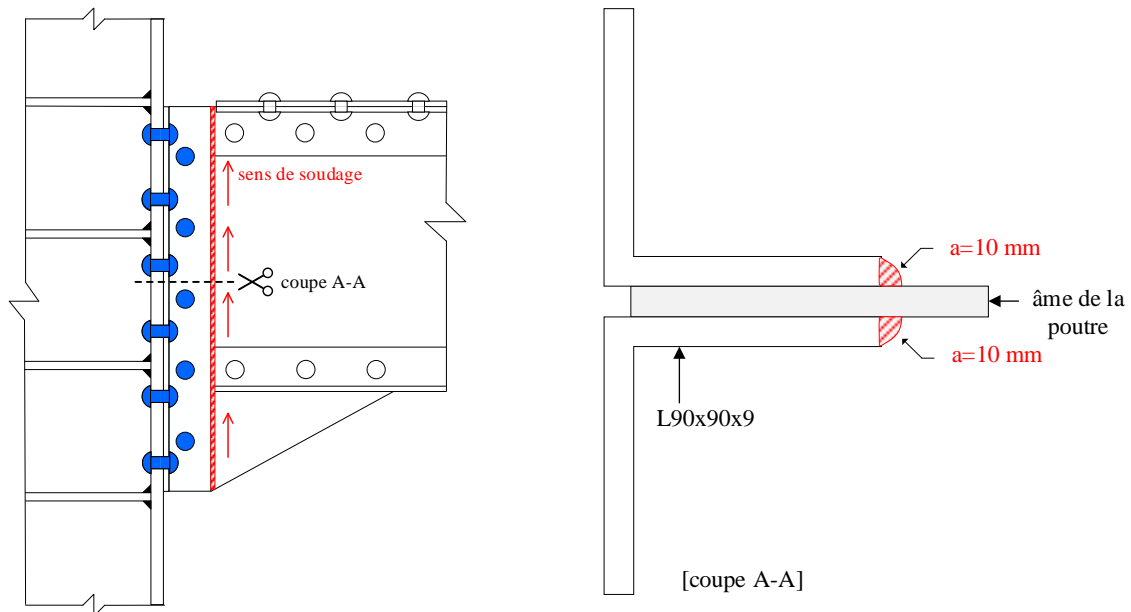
Soudage du spécimen AR-S-2
